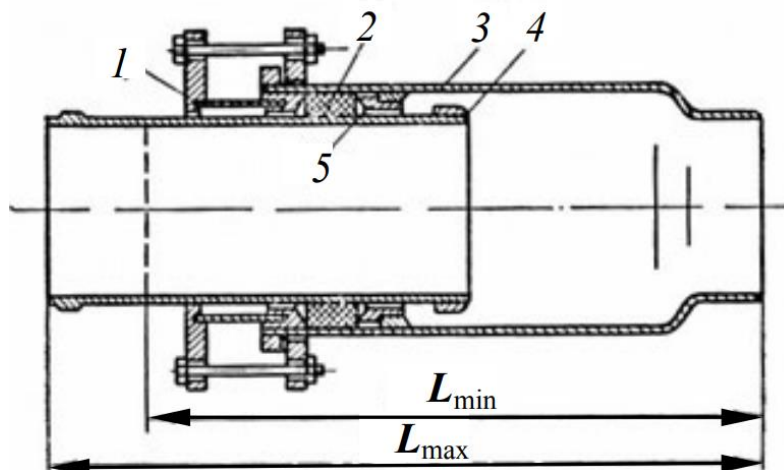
Сальниковый компенсатор: 1 – фланец; 2 – сальниковая набивка; 3 – корпус; 4 – стакан; 5 – упор
